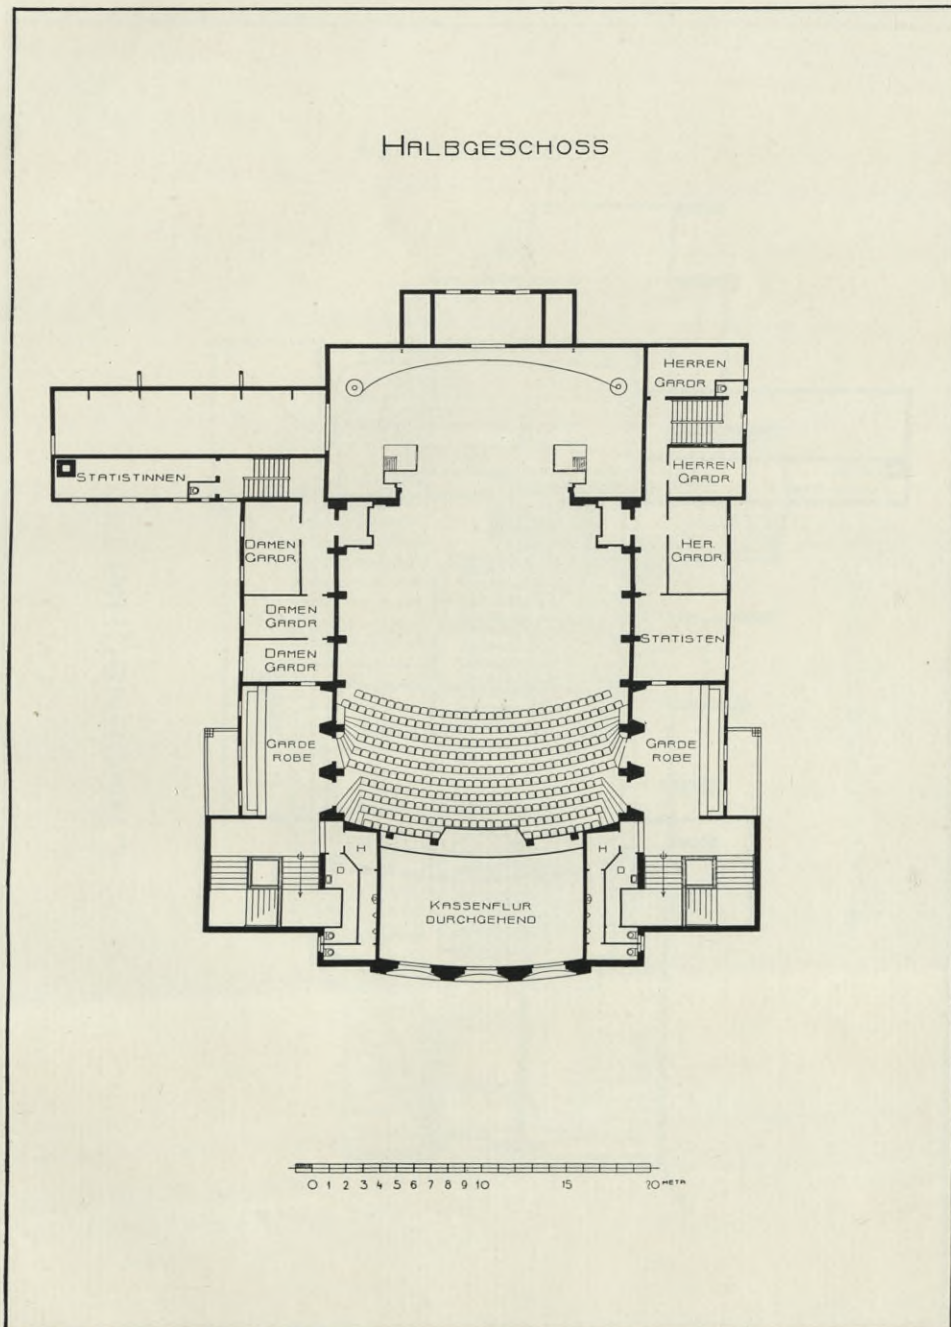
Künstler-Theater zu München. 121) Grundriß Halbgeschoß.
